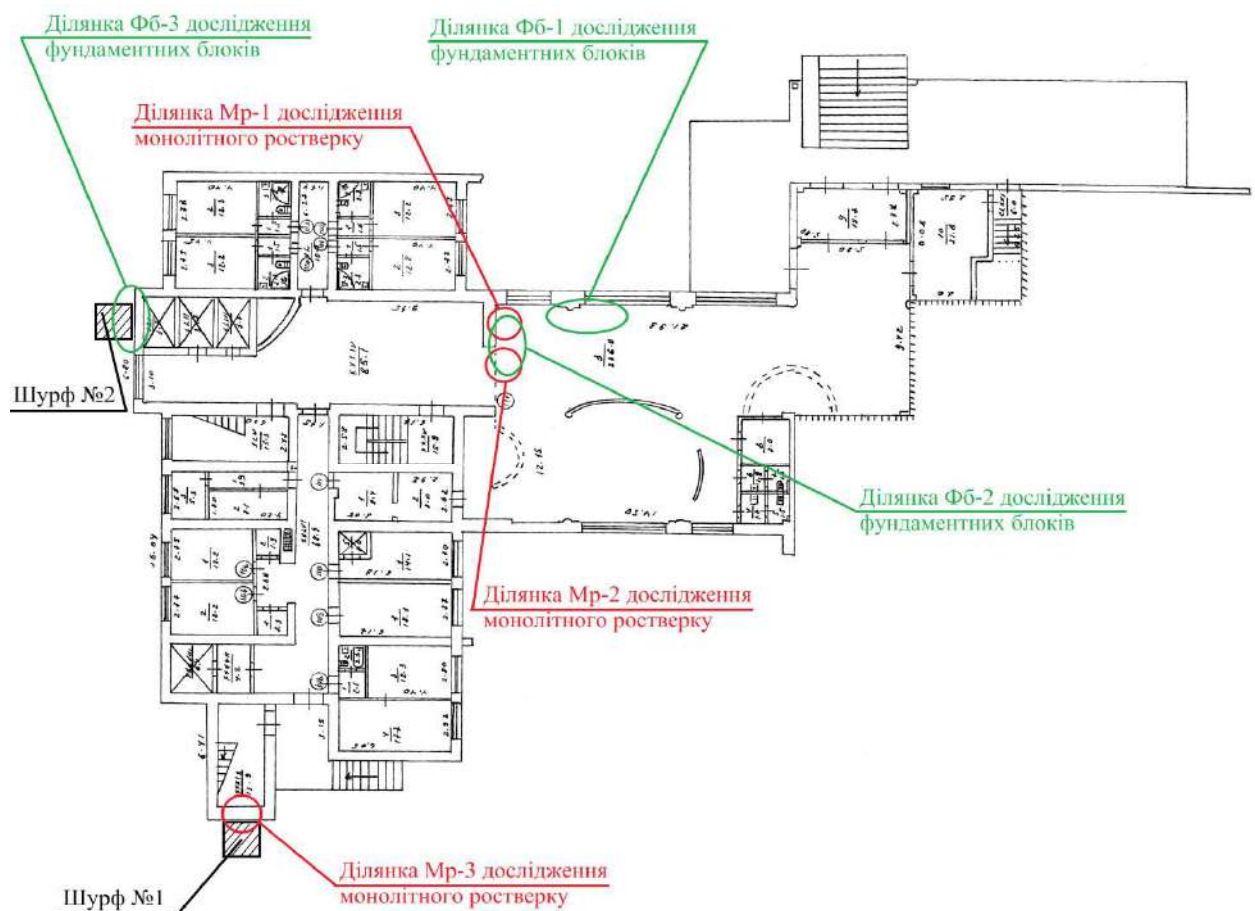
Схема розташування ділянок інструментального обстеження конструкцій фундаментів, що показана на плані першого поверху будівлі готелю
